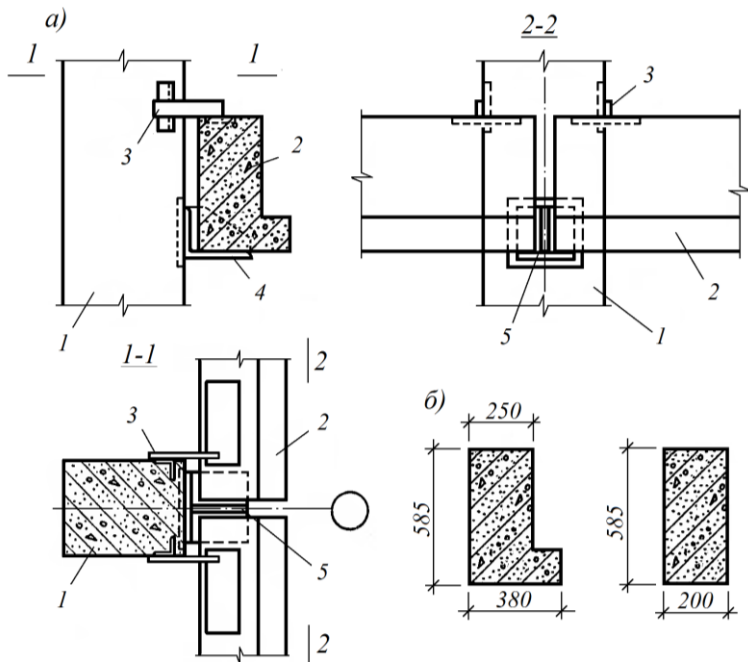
Кріплення залізобетонних обв'язувальних балок до колон: *а* – проєкції вузла кріплення; *б* – перерізи балок; 1 – колона; 2 – обв'язувальна балка; 3 – сталеві планки; 4 – опорний столик; 5 – ребро жорсткості
